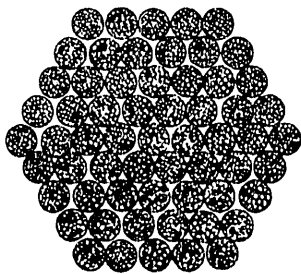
Puente de George Wáshington. Disposición de montaje de los cables
